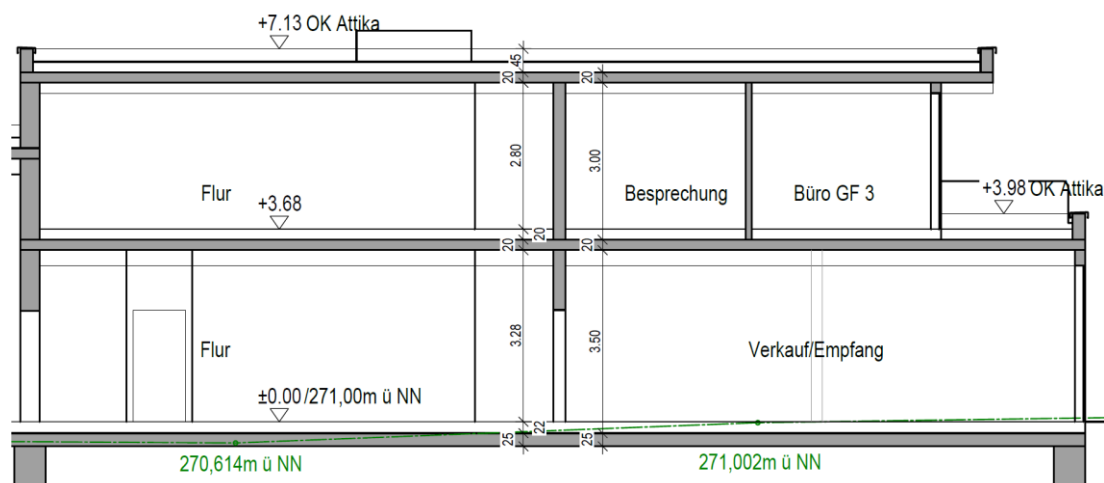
Beispiel 2-geschossiges Bürogebäude
